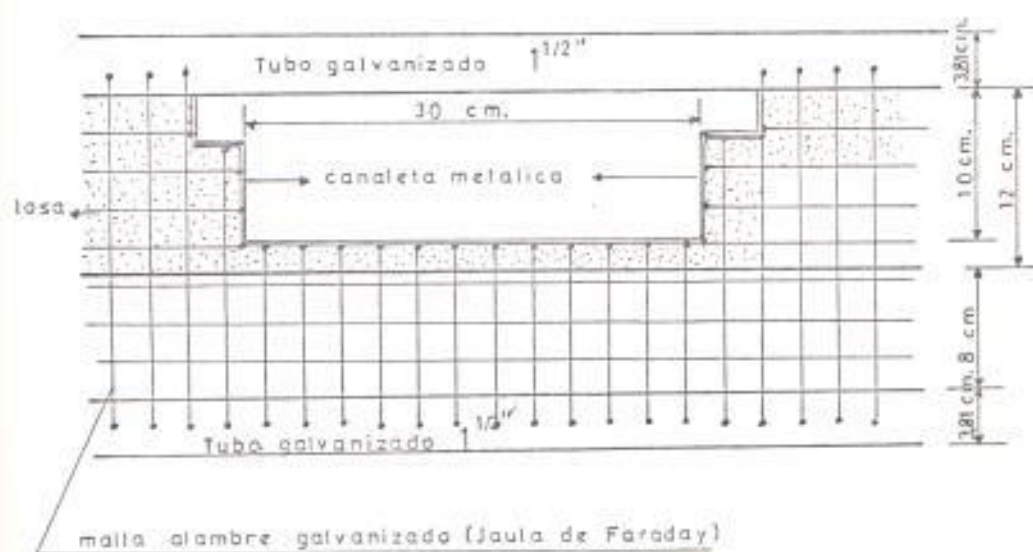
Detalle conexión canaleta a Jaula de Faraday.
